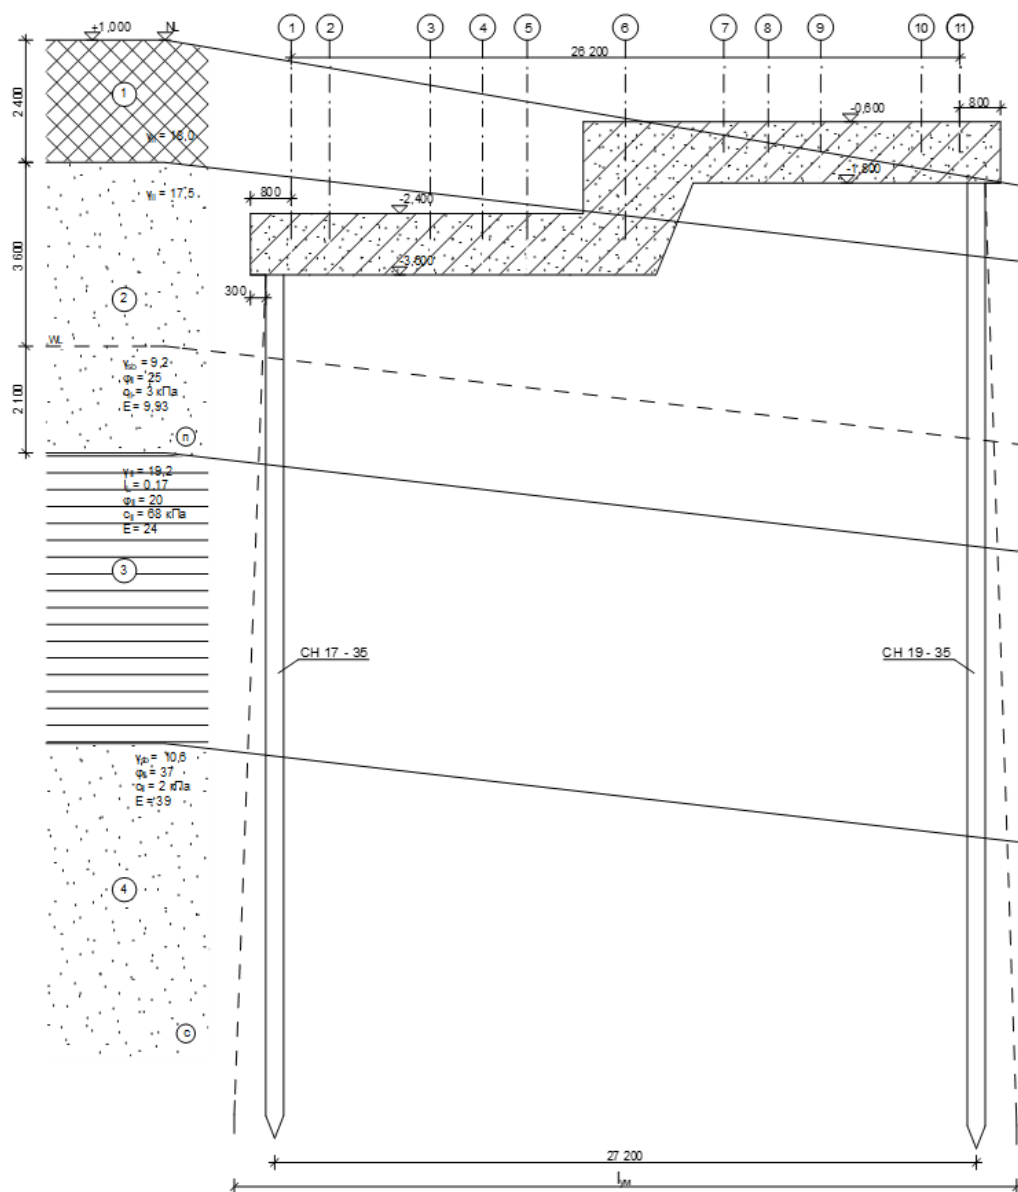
Розрахункова схема пальового фундаменту з забивних паль для розрахунку осідання за моделлю умовного фундаменту
